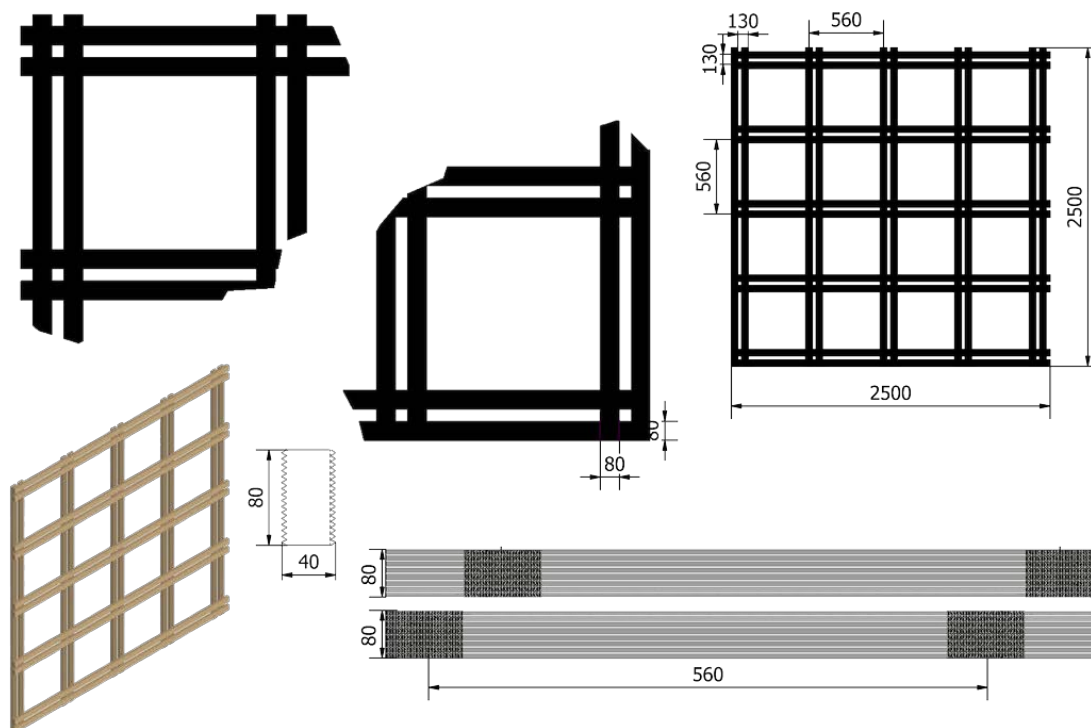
Plan de fabrication d'un mur ajouré d'ossature
